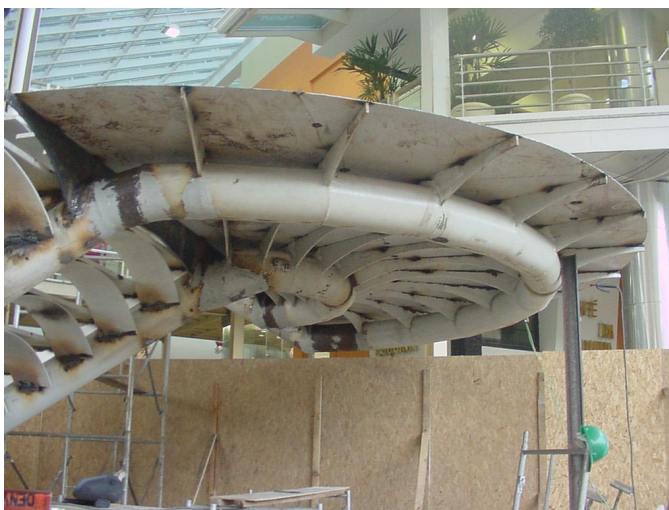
Detalhe escada em perfil tubular calandrado
